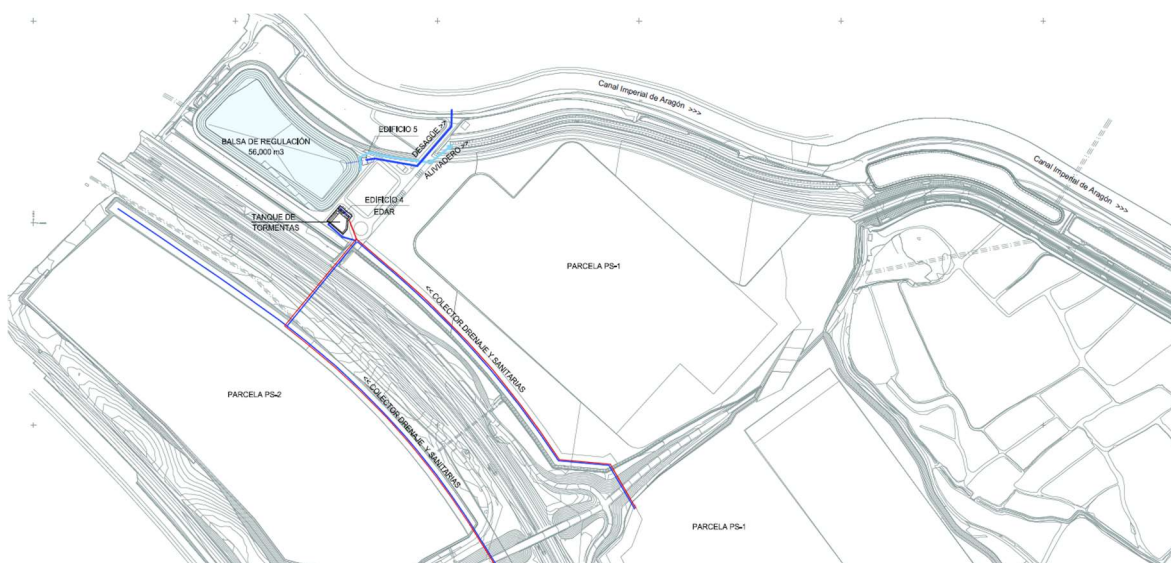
Extracto del plano 8.1 del Proyecto de Urbanización Exterior Privada
